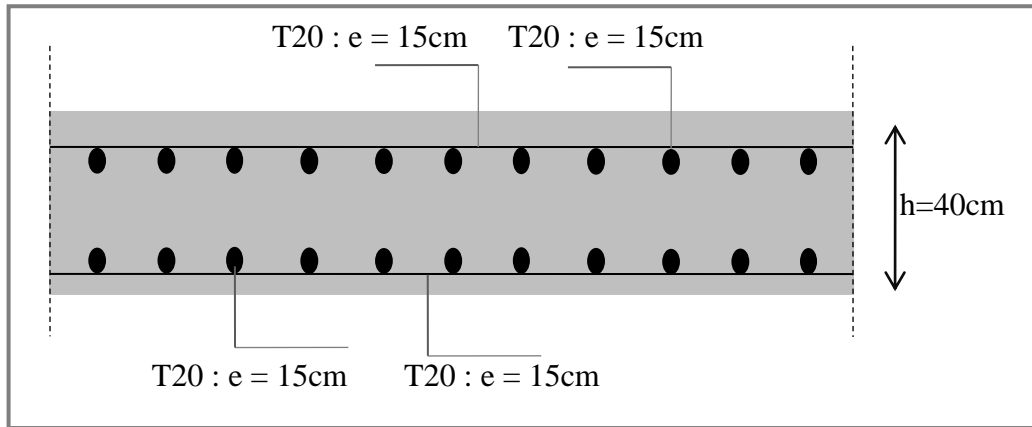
Ferrailage de la dalle du radier sens x-x
